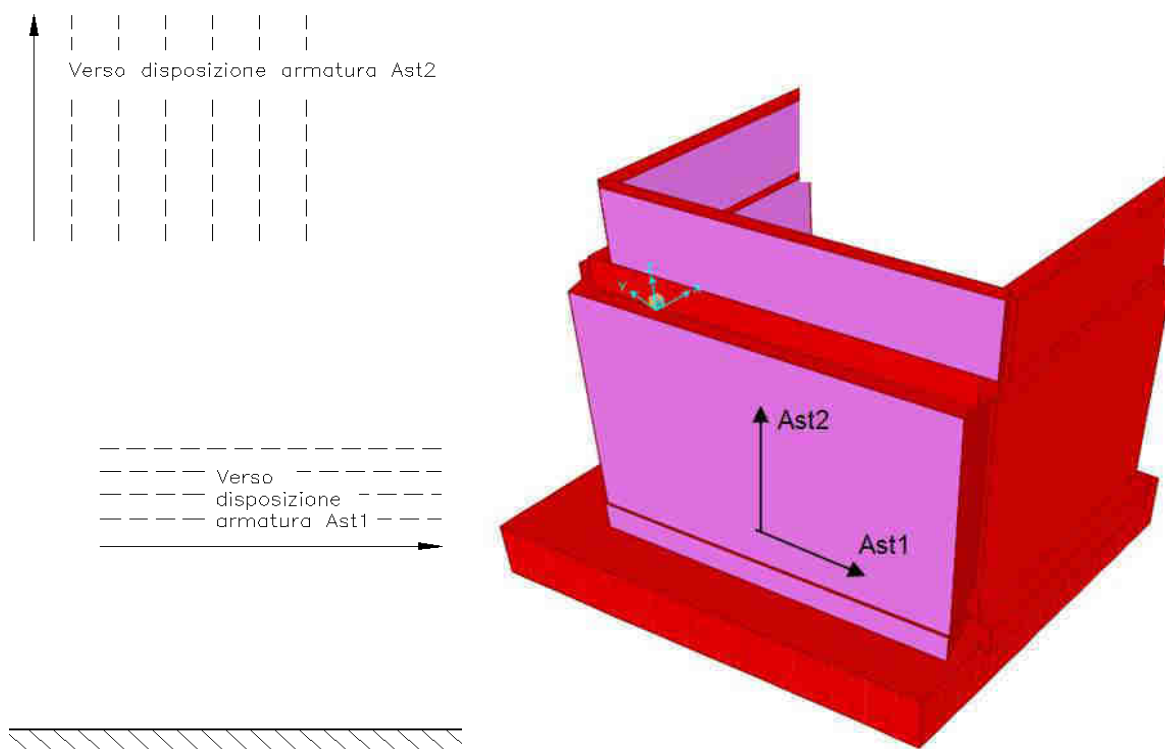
Richiesta di armatura elevazione: convenzioni
